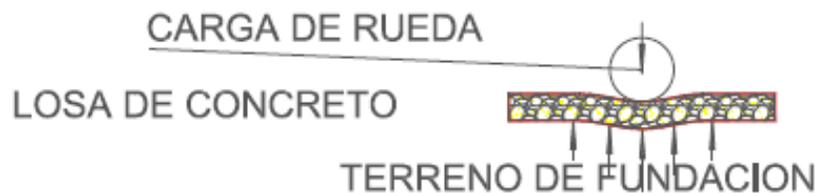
Transferencia de carga de una rueda en una estructura de pavimento rígido
